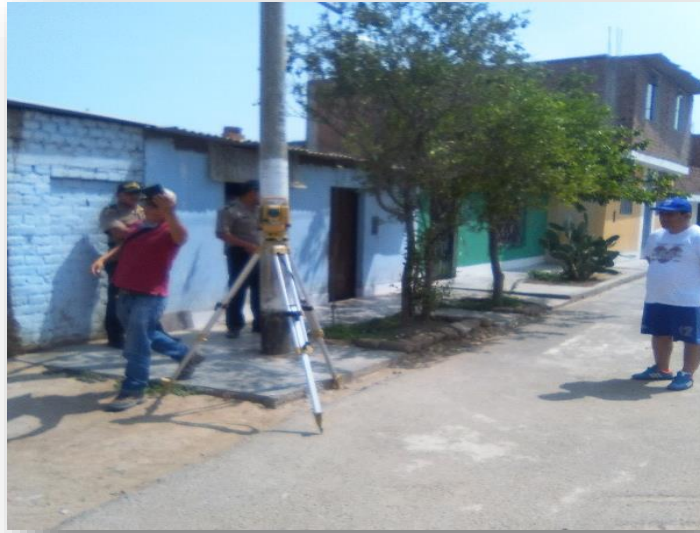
Siguiendo con el levantamiento topográfico por la Calle 26.
